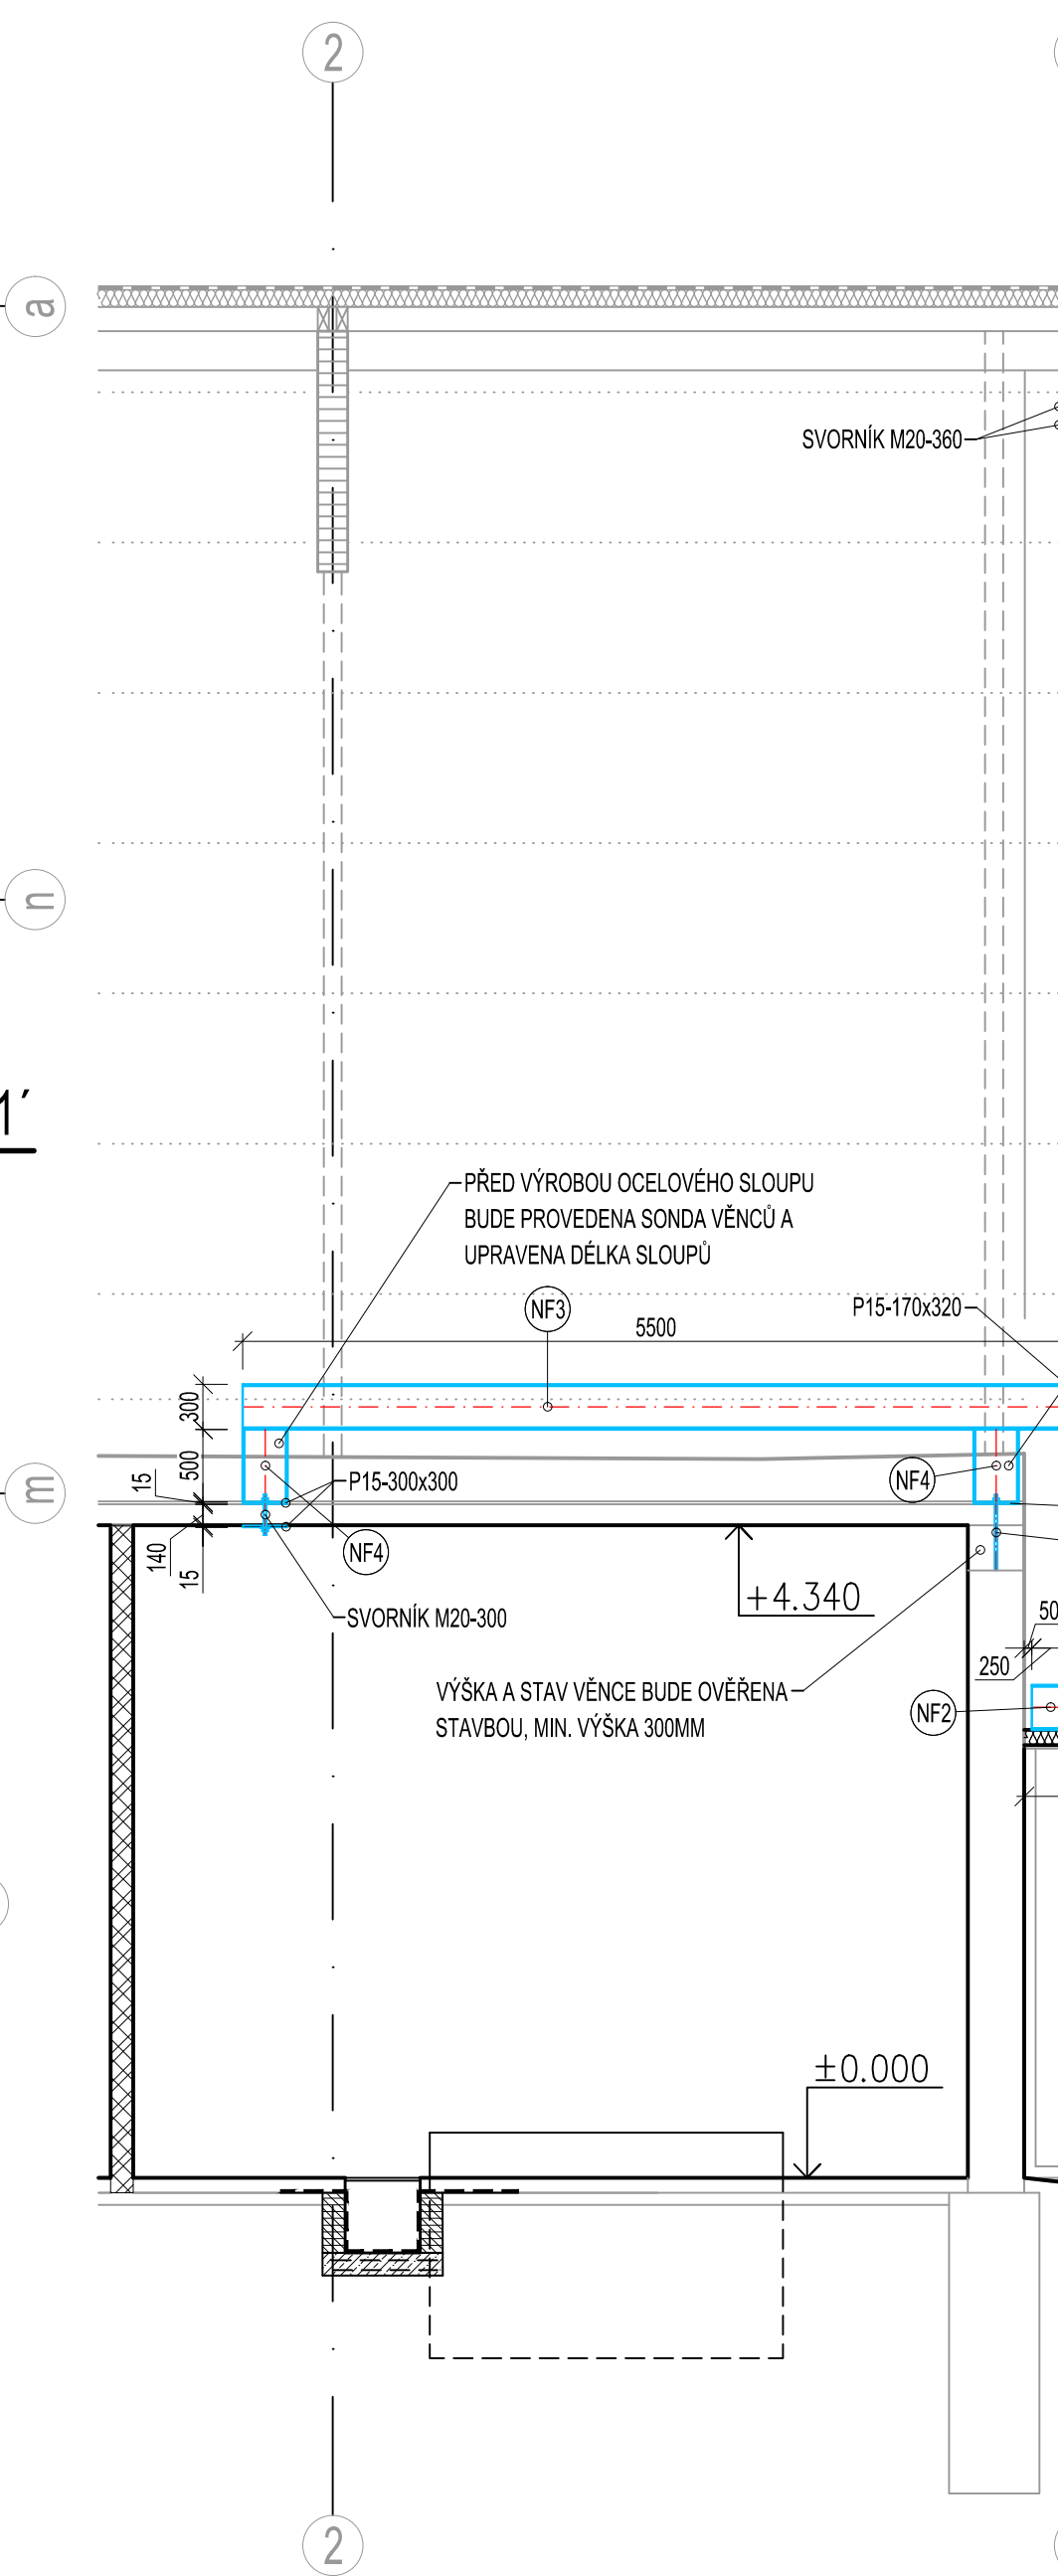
TYPICKÝ PŮDORYS, M1:25
